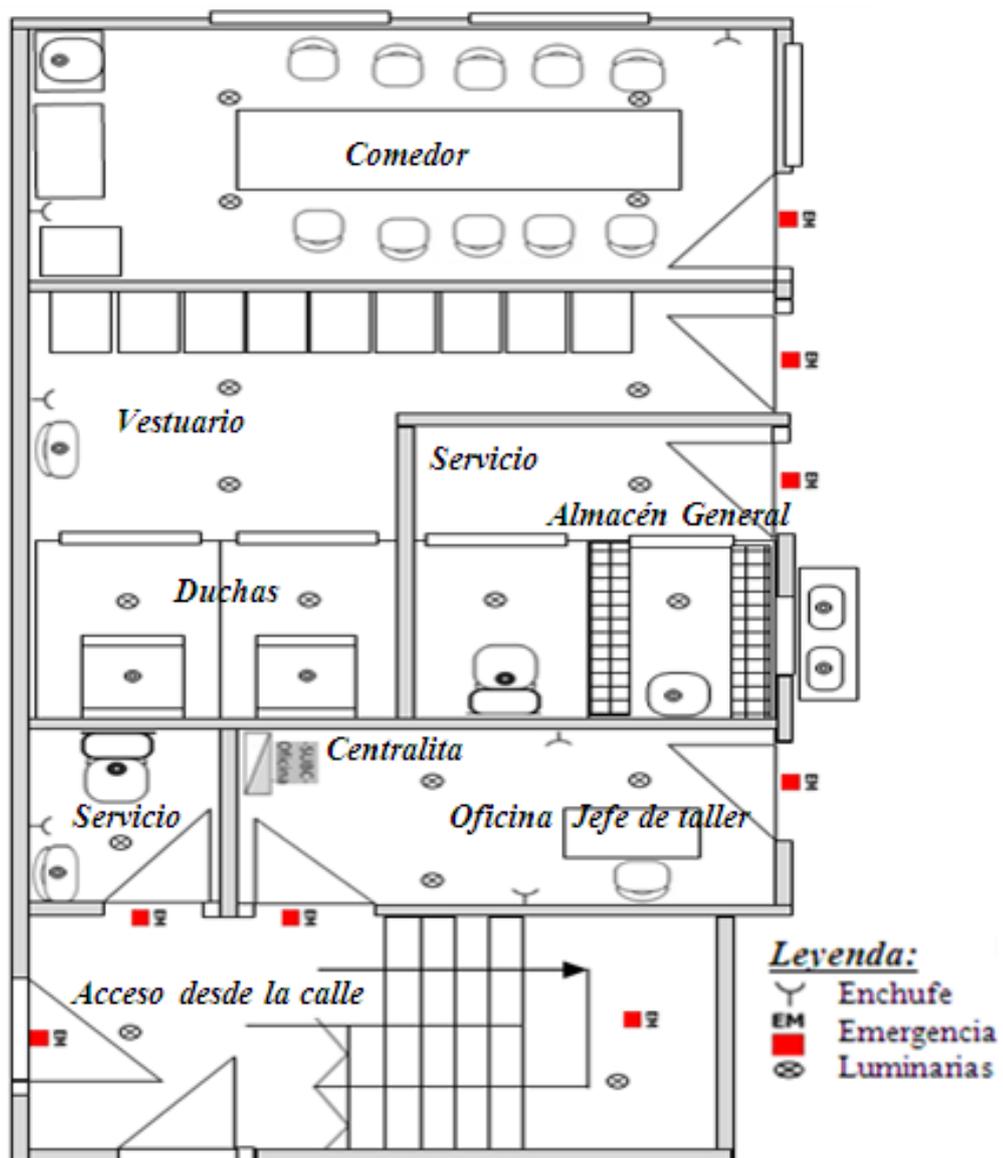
Croquis de distribución de la Planta baja (Elaboración propia).
